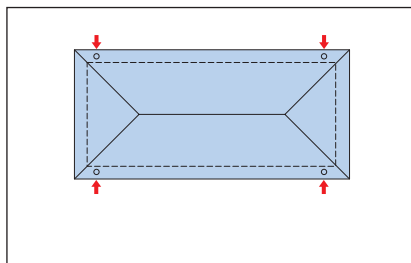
Walmdach – 2 Fallrohre auf beiden langen Seiten des Daches.
